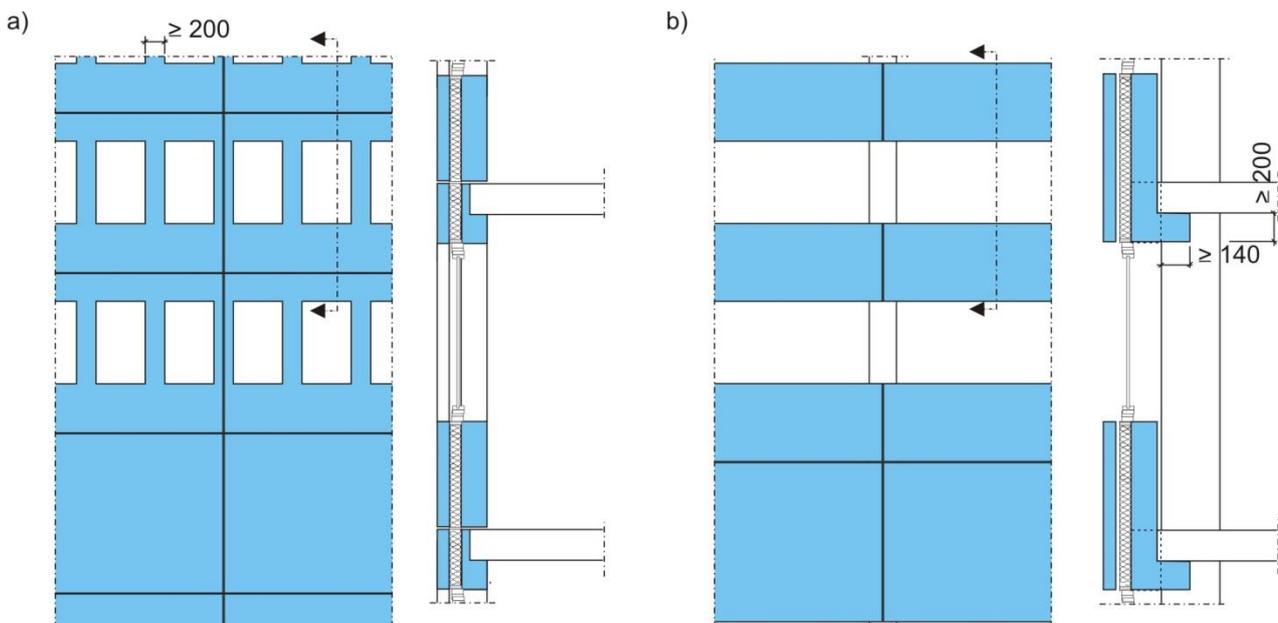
Schematische Ansichten und Fassadenschnitte bei zwei Tragwerksarten a) Fassade mit direkter Lastabtragung (hier: Lochfassade), b) Fassade mit Lastabtragung durch Stützen (hier: Bandfassade)
